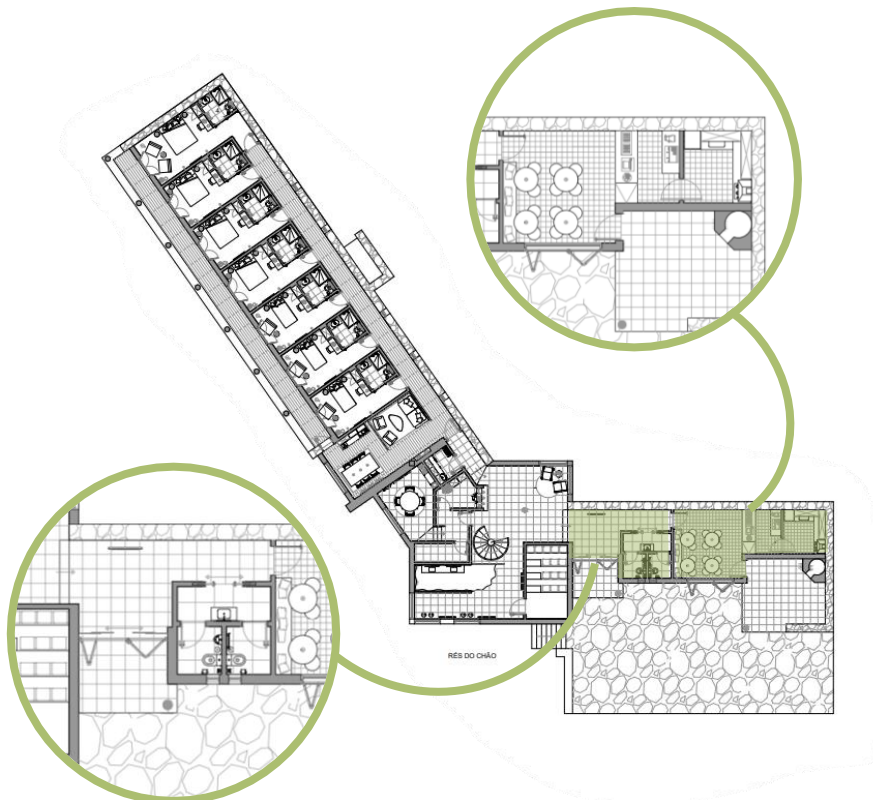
Planta de Apresentação com detalhes das zonas de entrada e bar. Fonte: Autor.
